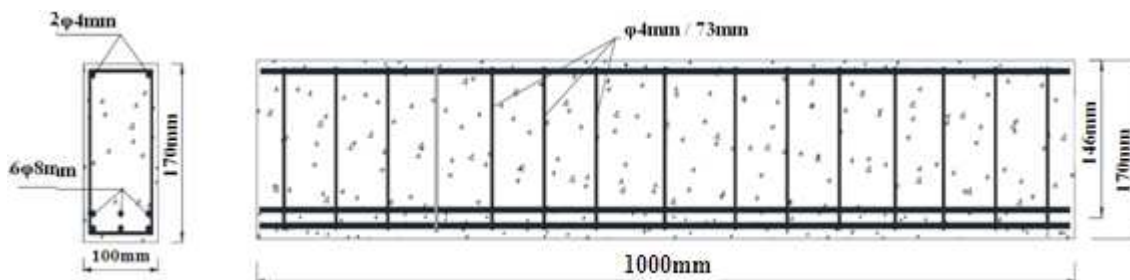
Dimensões e armaduras das vigas de ATSHAN (2012, p.291).
